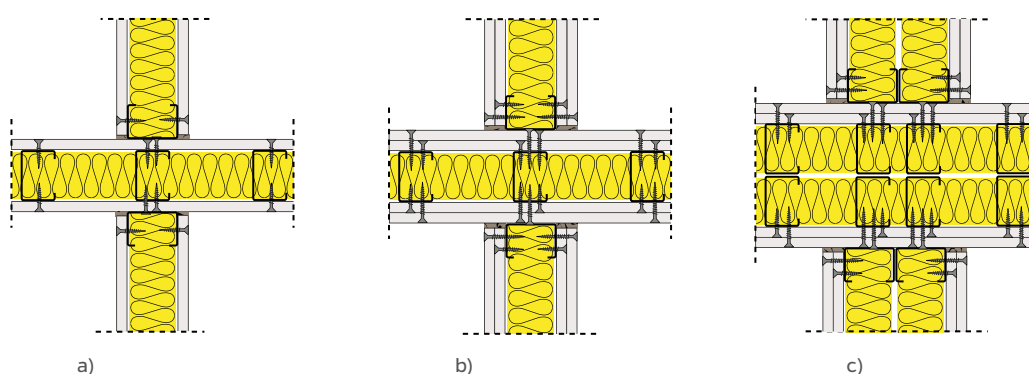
Ligações em encontros em cruz: a) Estrutura simples – placa simples;
